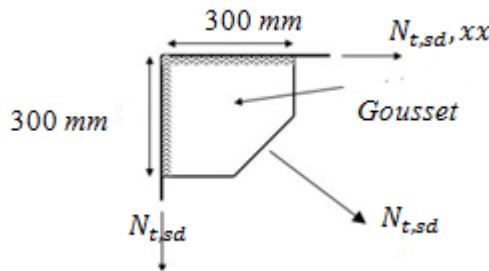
Assemblage gousset - nœud de portique par soudure.
